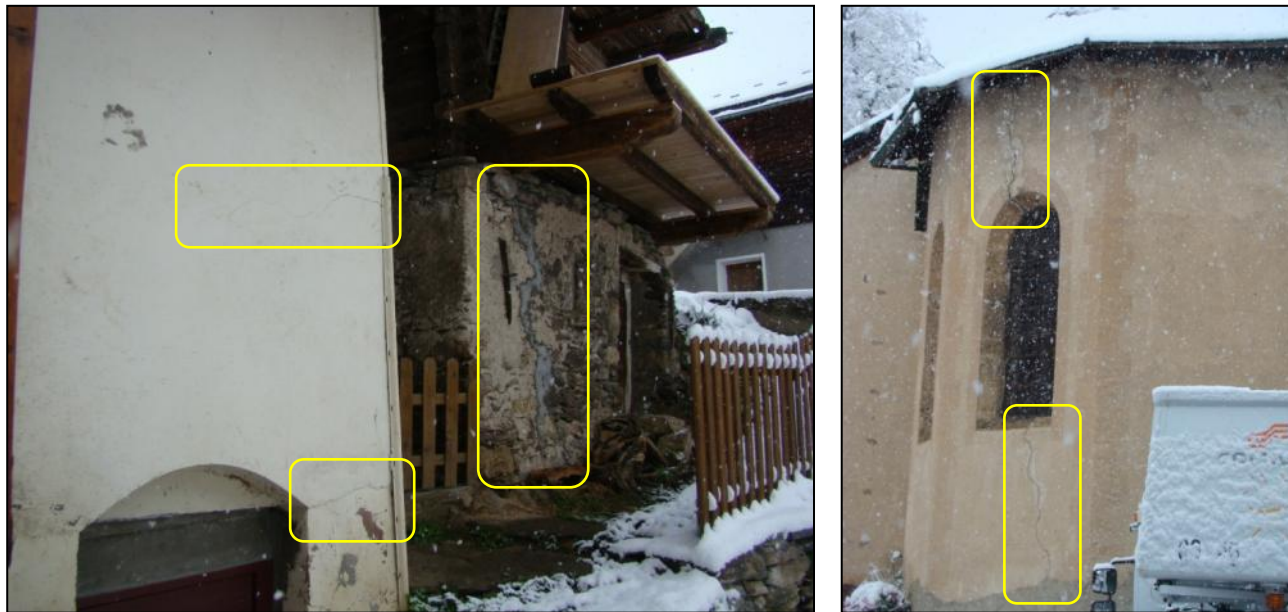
Fissuration sur les constructions et l'église dans le village de Hauteluce [Source : IMS_{RN}]
